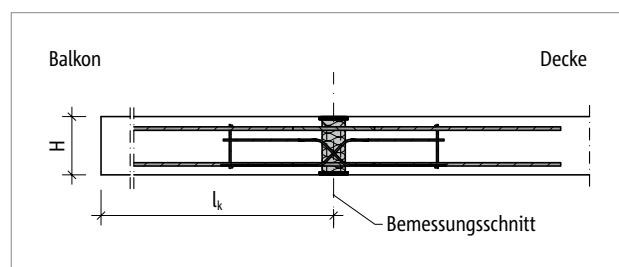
Schöck Isokorb® T Typ DL: Statisches System
